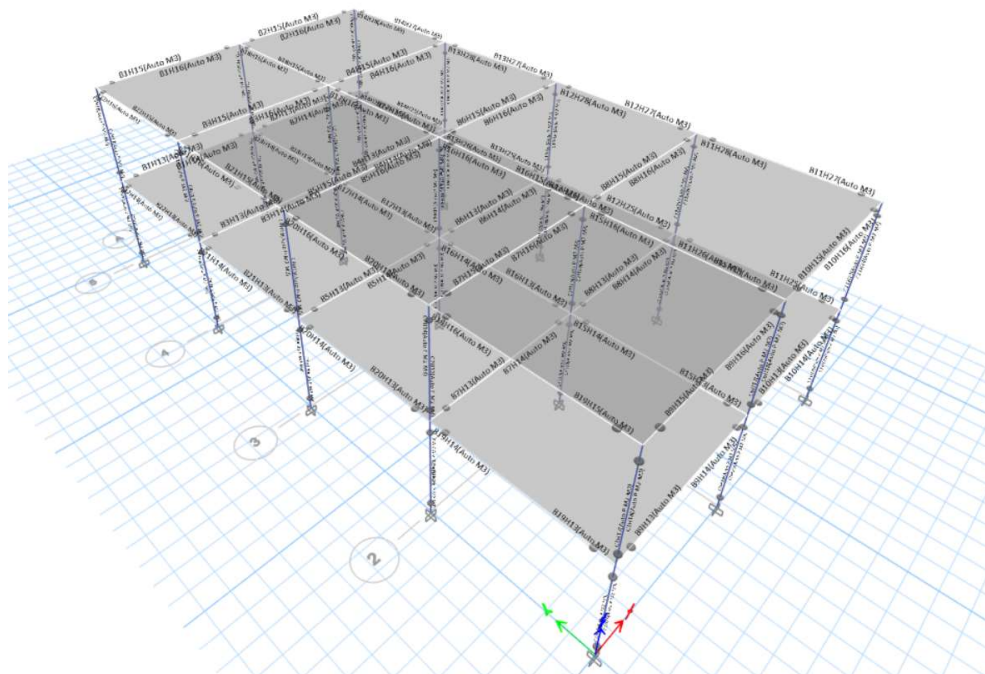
Ubicación de las rotulas plásticas en vista en 3D
